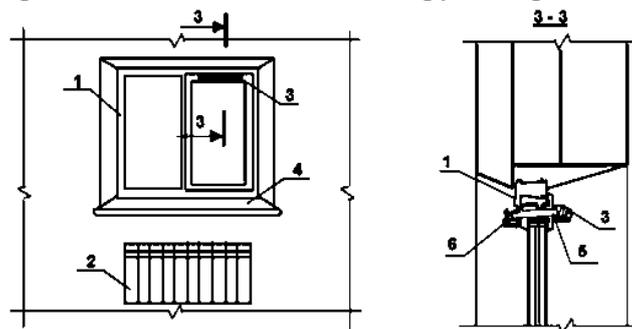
Схема монтажа оконного приточного вентиляционного клапана Air Vox Comfort: 1 – оконный блок, 2 – прибор отопления, 3 – оконный вентиляционный клапан, 4 – подоконник, 5 – планка монтажная, 6 – наружный козырек
